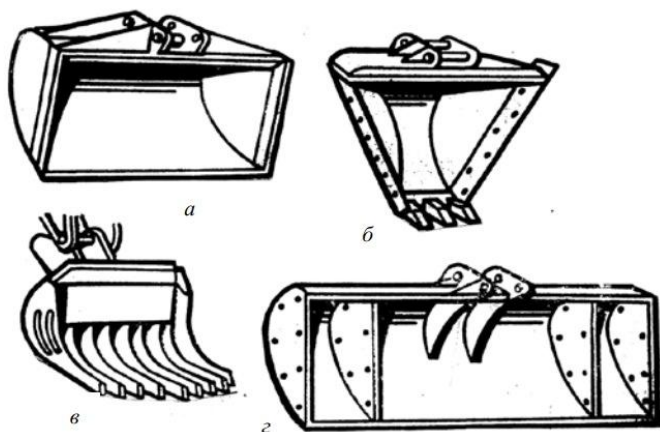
Виды сменных рабочих органов циклического действия: а – уширенный ковш с прямой режущей кромкой; б – профильный ковш; в – вилы; г – уширенный ковш с перегородками.
